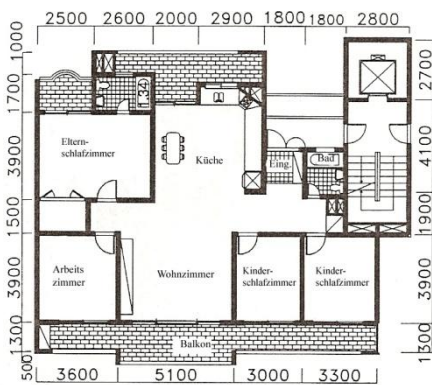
Grundriss der Sang-Gae-Wohnhochhaus-Siedlung mit Wohnflächen von 135m² und 83 m²
